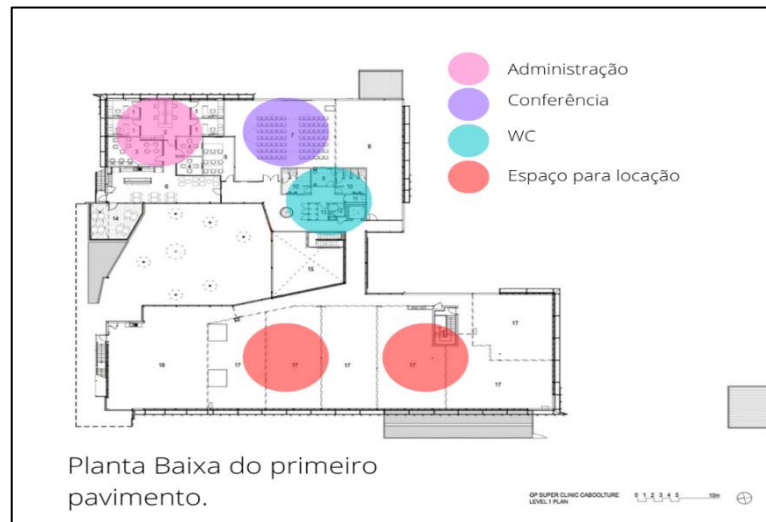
PLANTA BAIXA DA CLÍNICA
